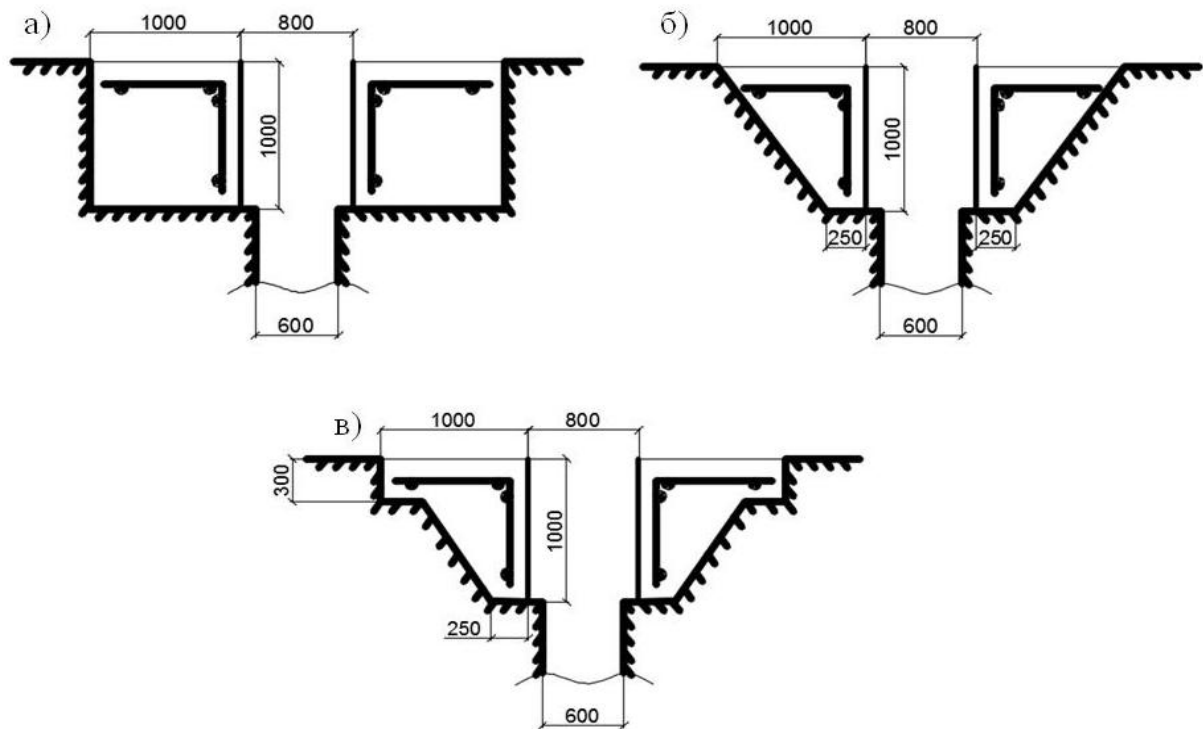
Формы поперечного сечения монолитных форшахт при низком уровне грунтовых вод:
